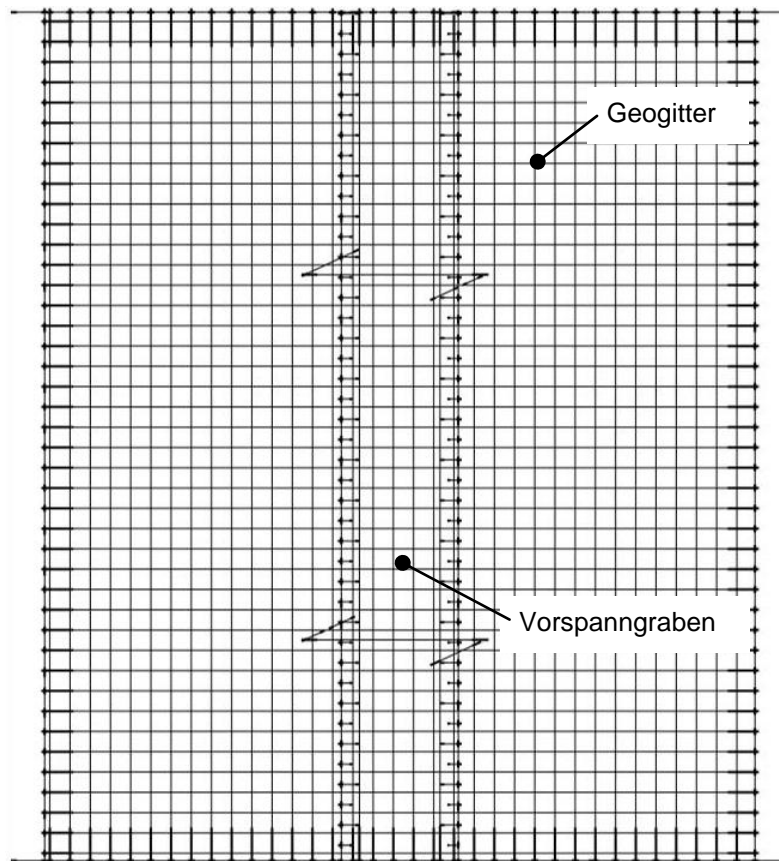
Auflegen des Geogitters – Grundriss
